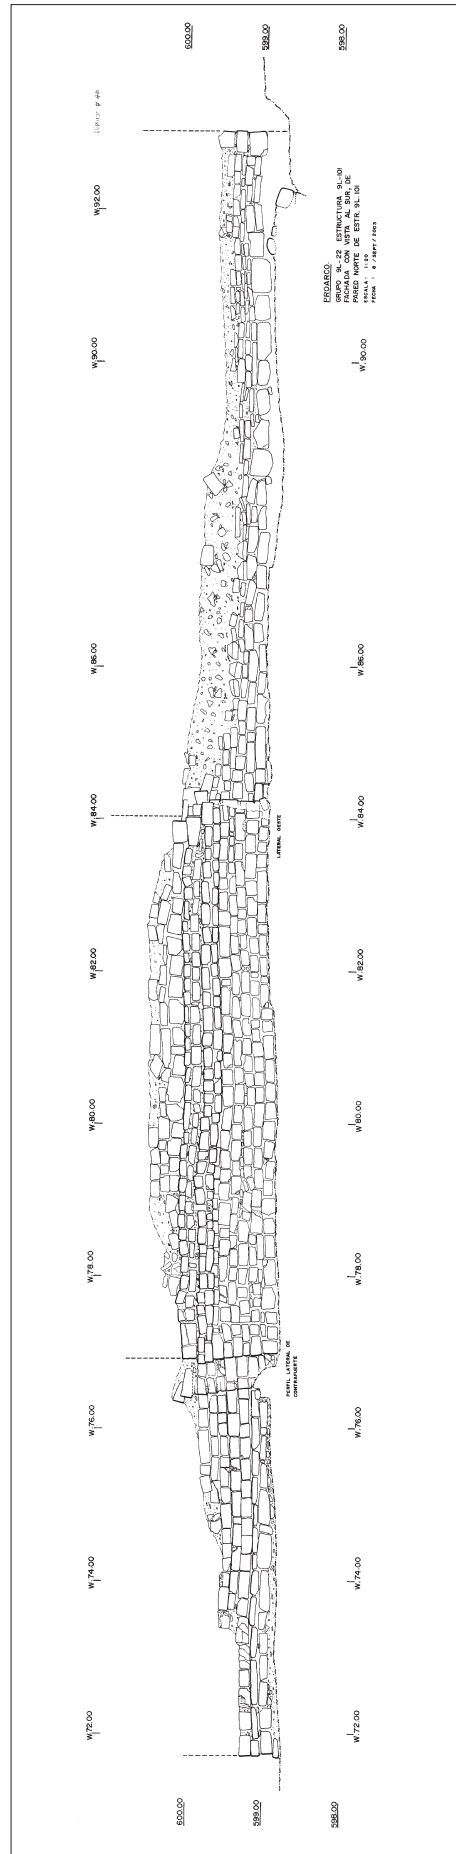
Fachada norte de 9L-101-1^a y los anexos, vista al sur
